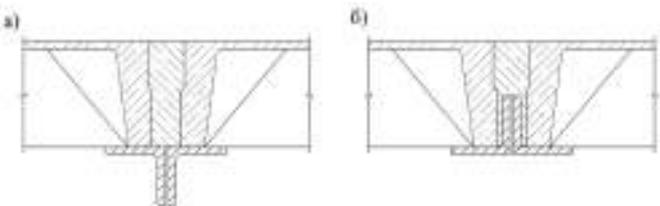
Конструктивное решение перекрытия со сборными железобетонными ребристыми плитами длиной 6 или 12 м: а) опирание на верхний пояс фермы; б) опирание на нижний пояс фермы
